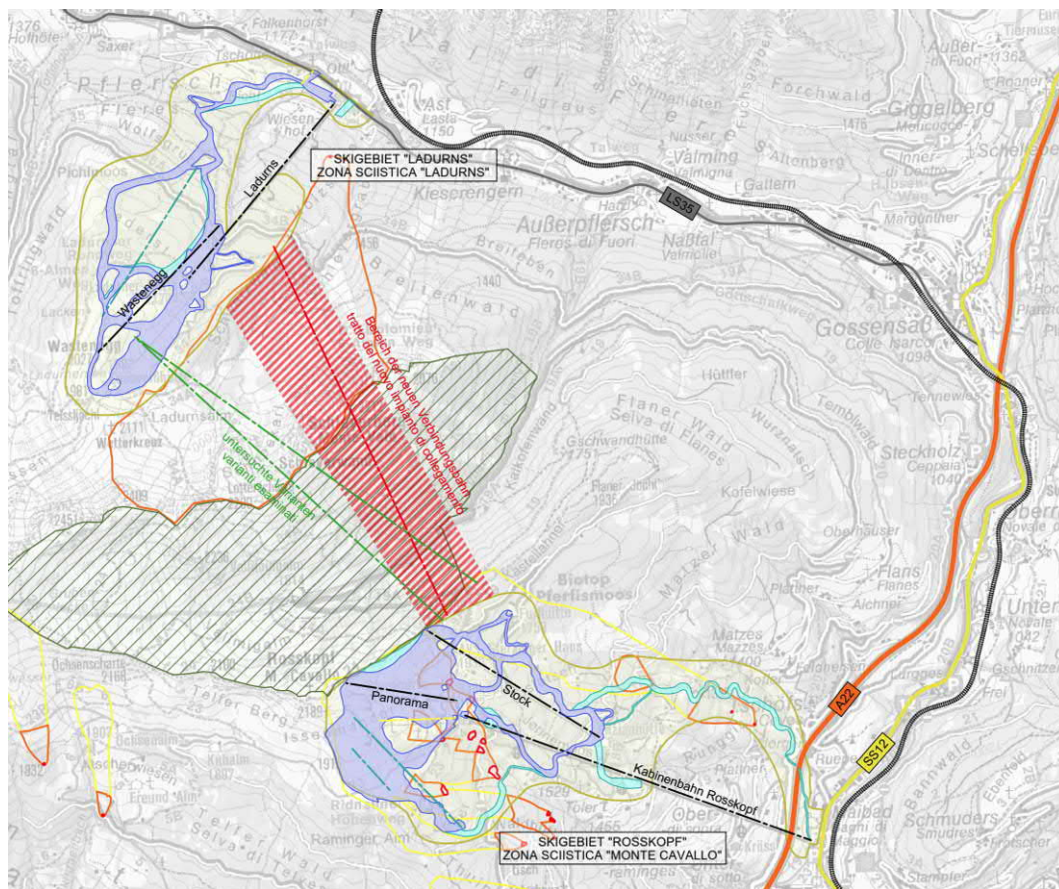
Übersichtslageplan mit Projekt, Varianten und Straßennetz
